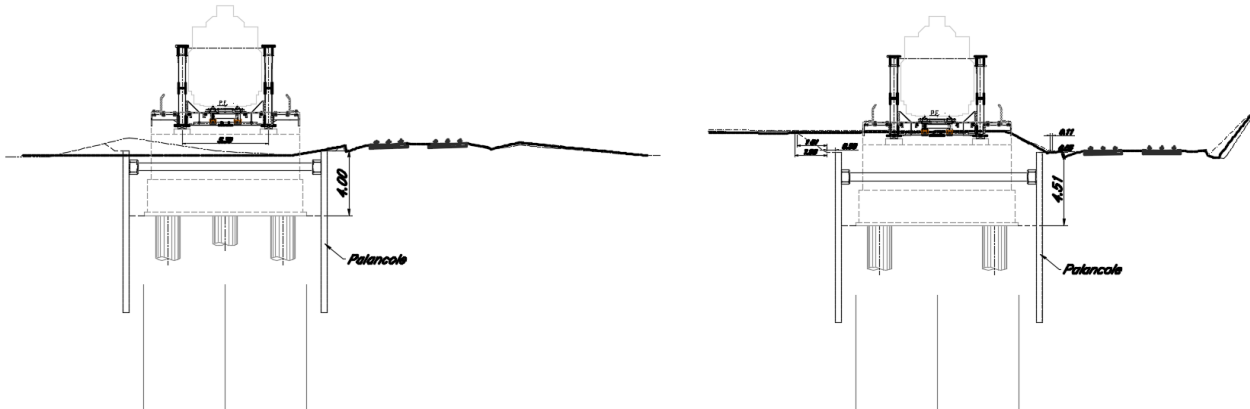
VIADOTTO VI 01 –Sezioni Trasversali. Sinistra Spalla A. Destra Spalla B
